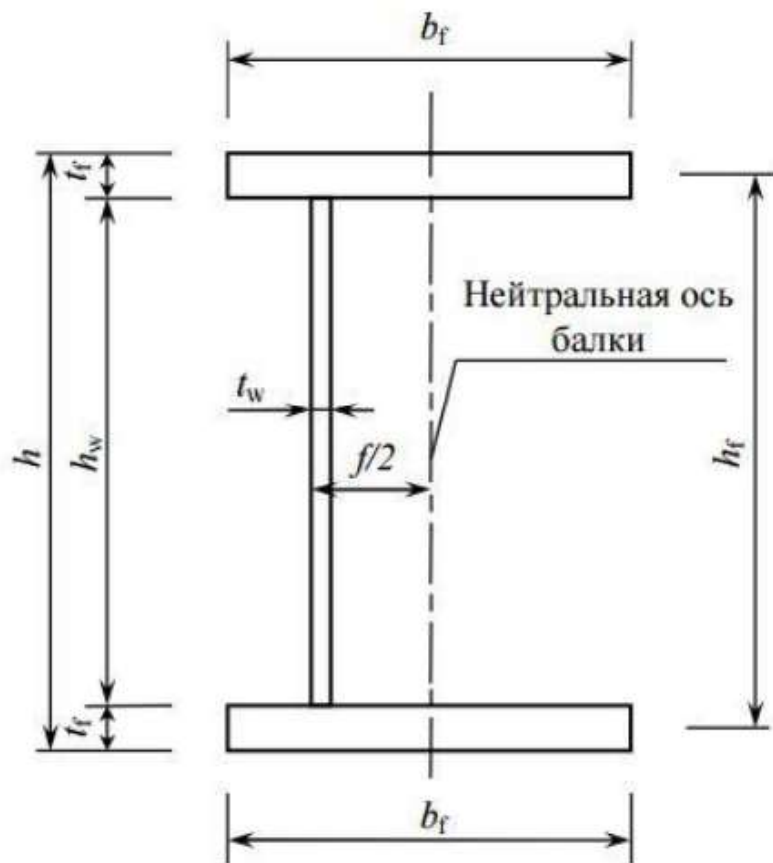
Поперечний переріз балки з гофрованою стінкою
